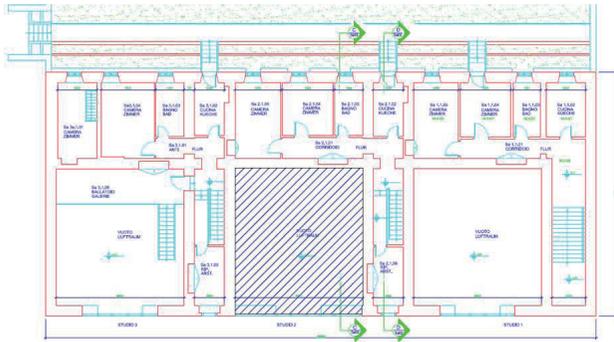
Zoneneinteilung Grundriss 1. OG (ohne Maßstab)
